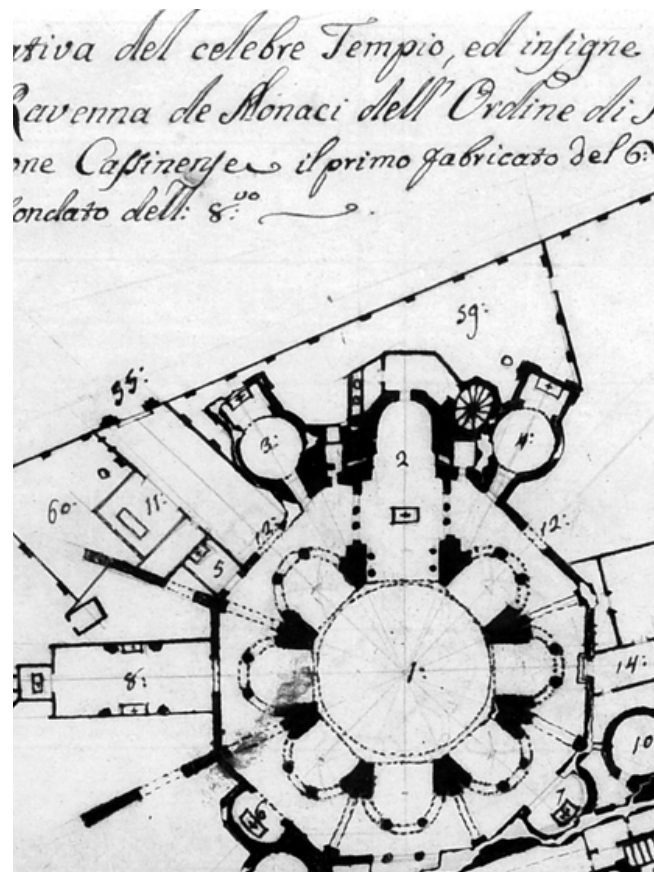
Particolare della planimetria di Benedetto Fiandrini
